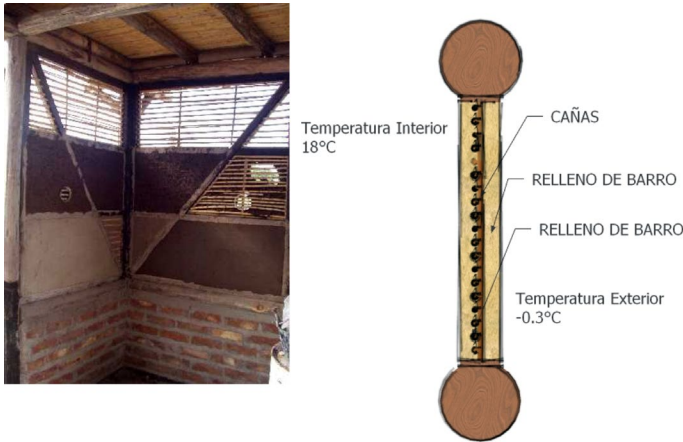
Taller experimental en etapa de construcción. Detalle de armado del muro de quincha. Fuente: Elaboración de los autores.
